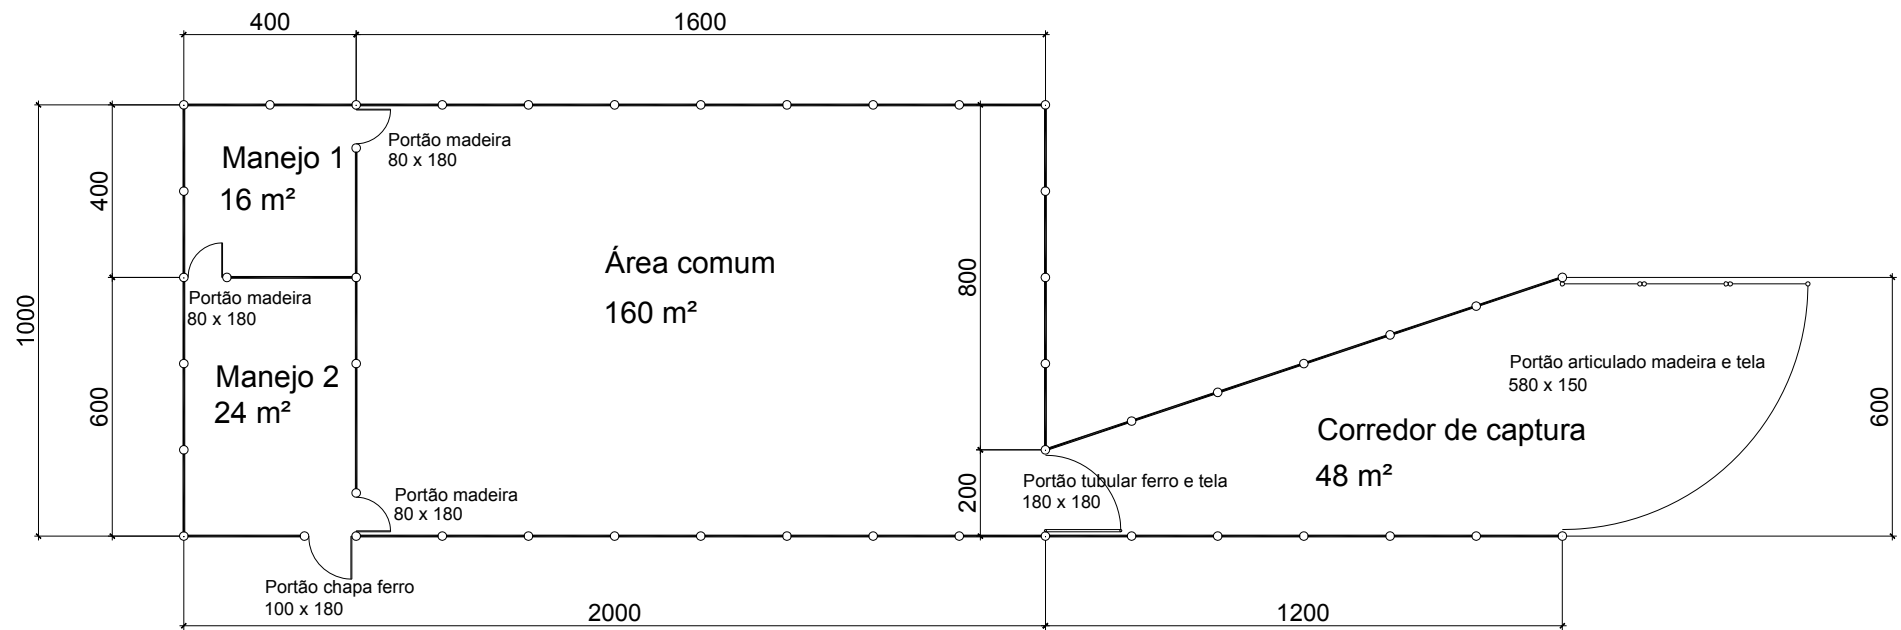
PLANTA BAIXA DO RECINTO DE CAPTURA
